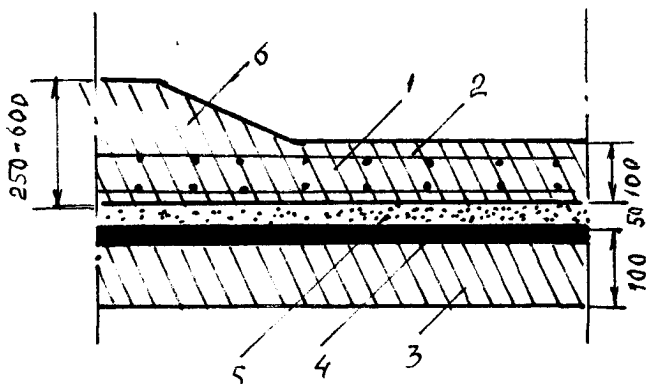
Конструкція залізобетонних резервуарів:
